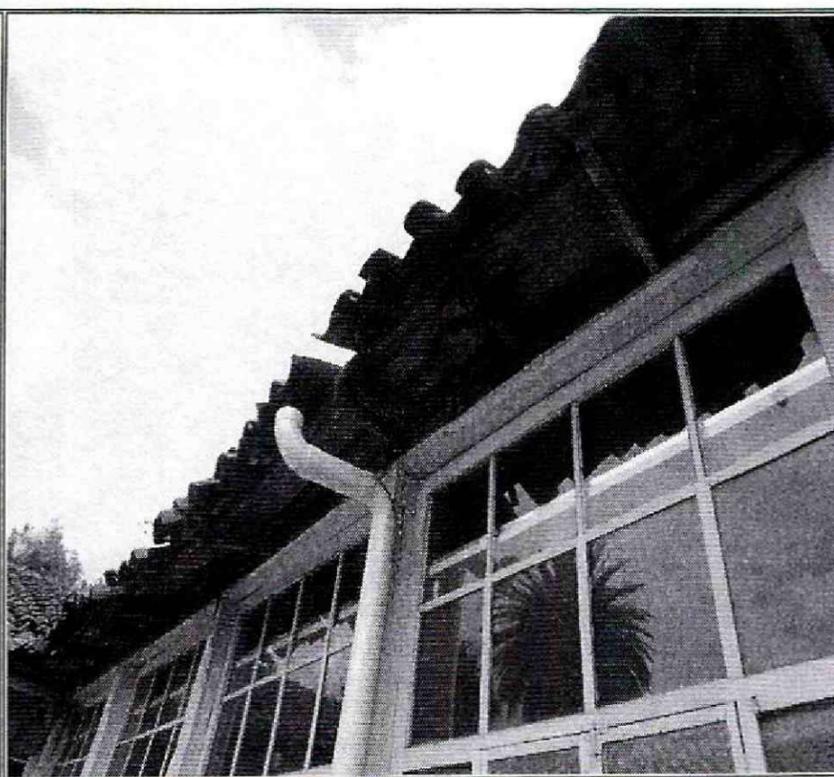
Cielo raso en madera exterior de "La Casona"
